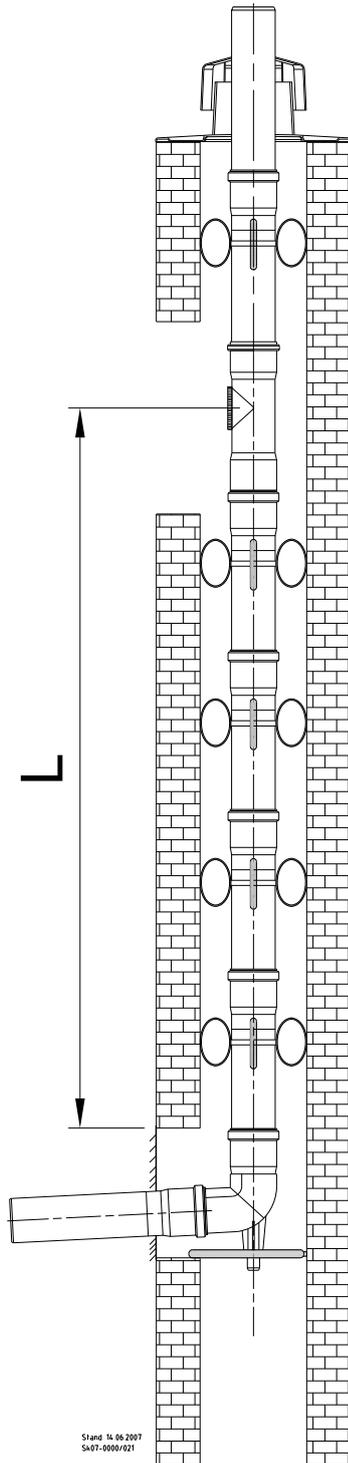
Abgasrohre mit Stoppring-Technik ①
